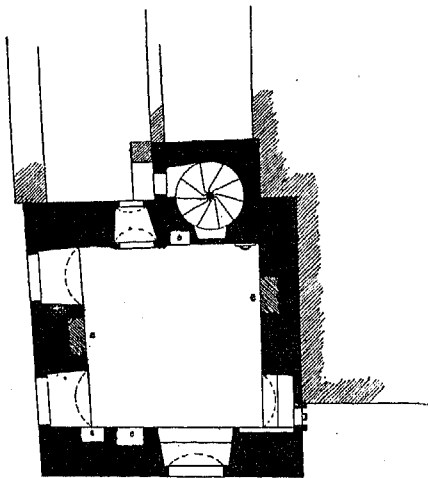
Grundriss des I. Stockwerkes.
